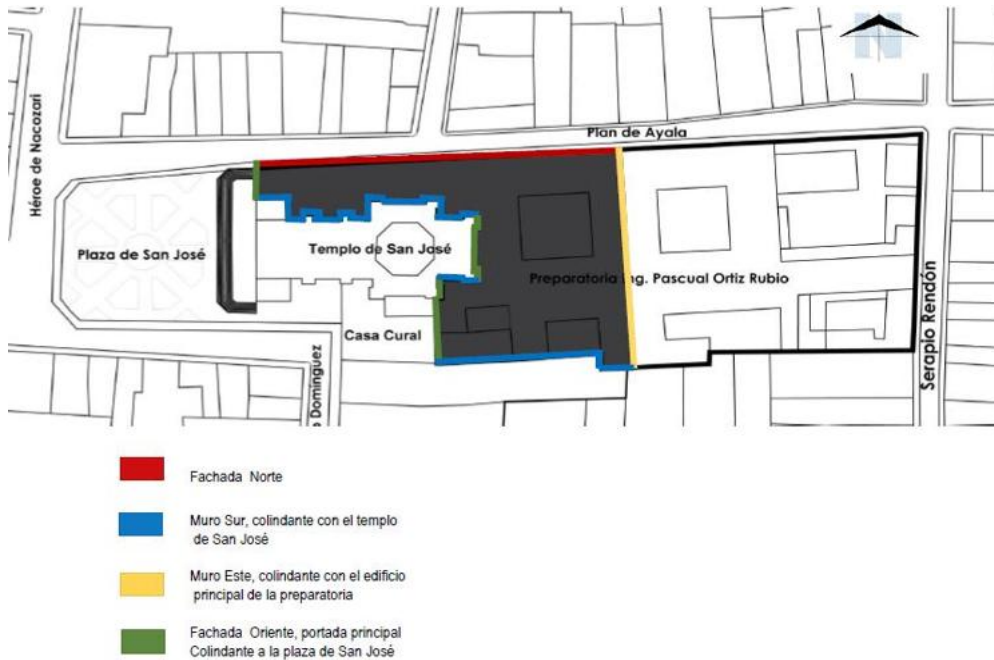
Croquis de la orientación de cada una de las fachadas del edificio.⁸³
